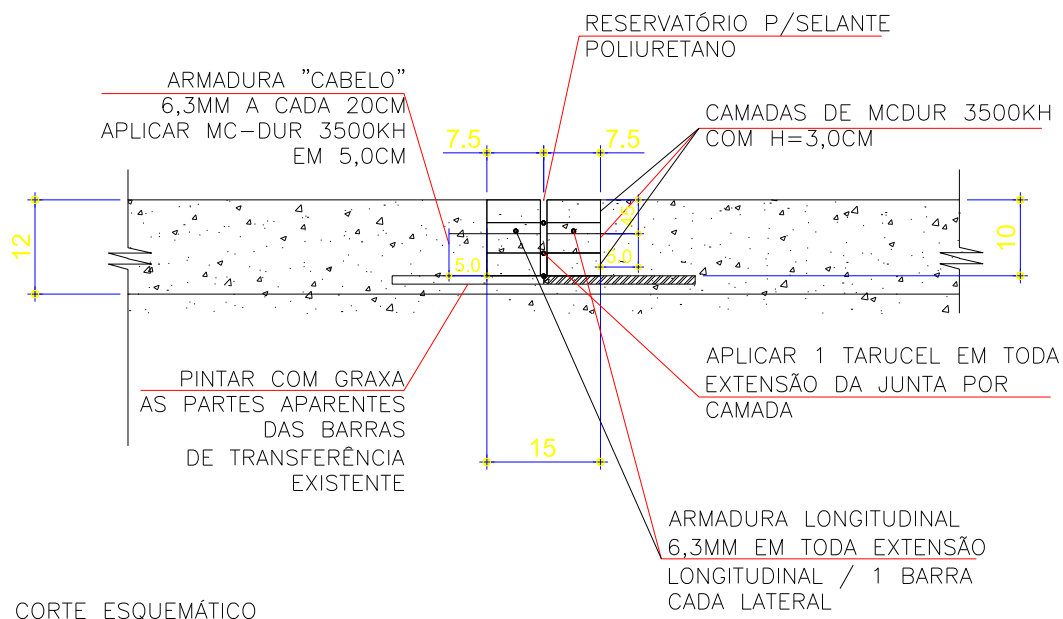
CORTE ESQUEMÁTICO JUNTA PISO OPERACIONAL
